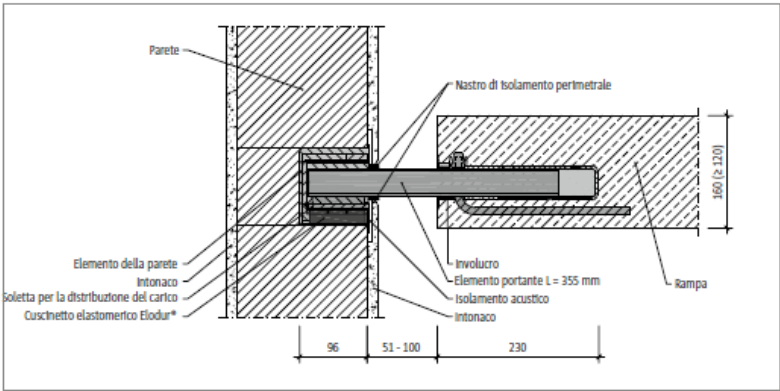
Schöck Tronsole® tipo Q-FV-XL o Q-A2-XL, sezione costruttiva
